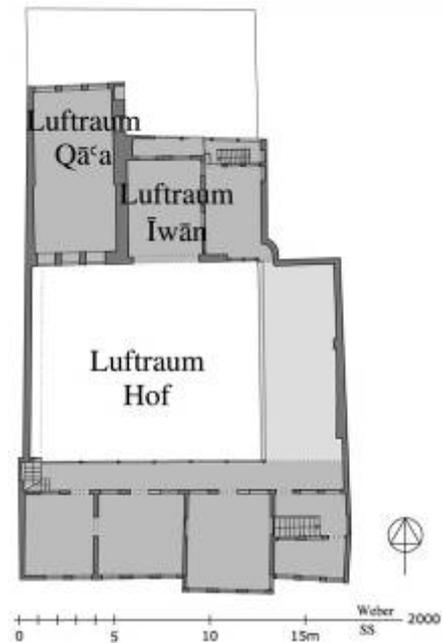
Bayt 'Ağamī, Grundriss OG
